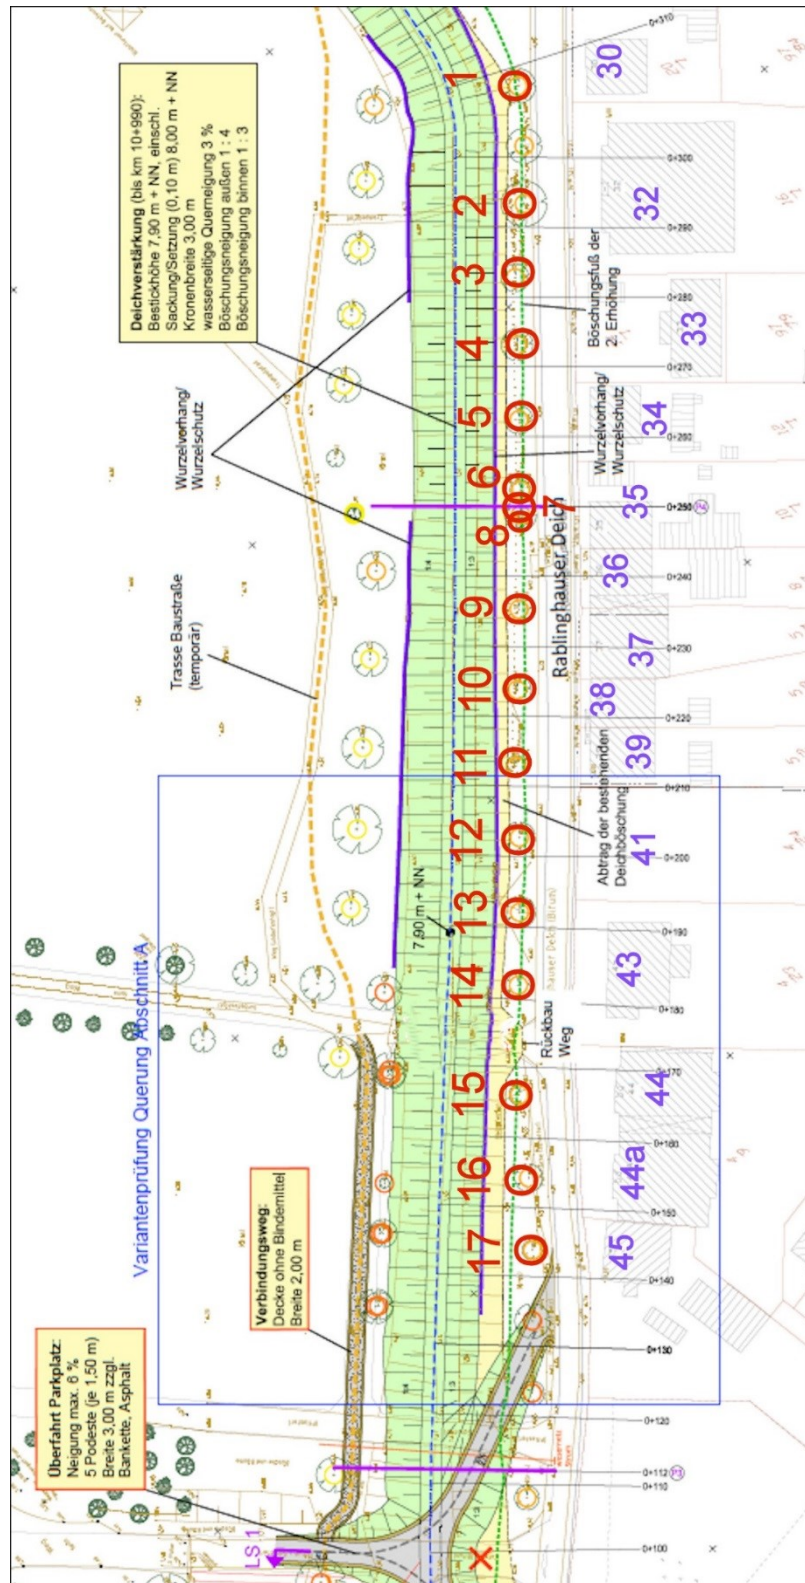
Plan-skizze ohne Maßstab; Bäume und Baumnummern: rot; Hausnummern: violett
